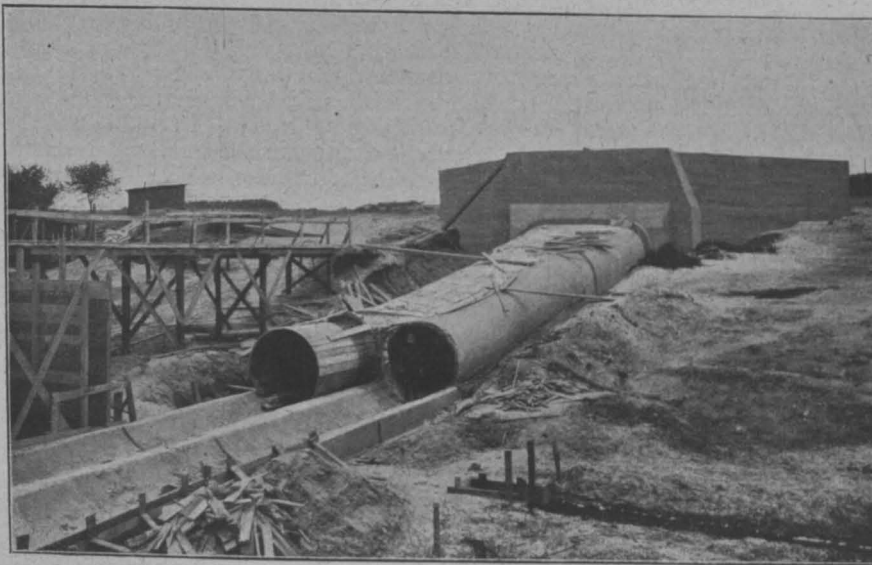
Ausführung der Dückeranlage mit Eisenbetonrohren.
